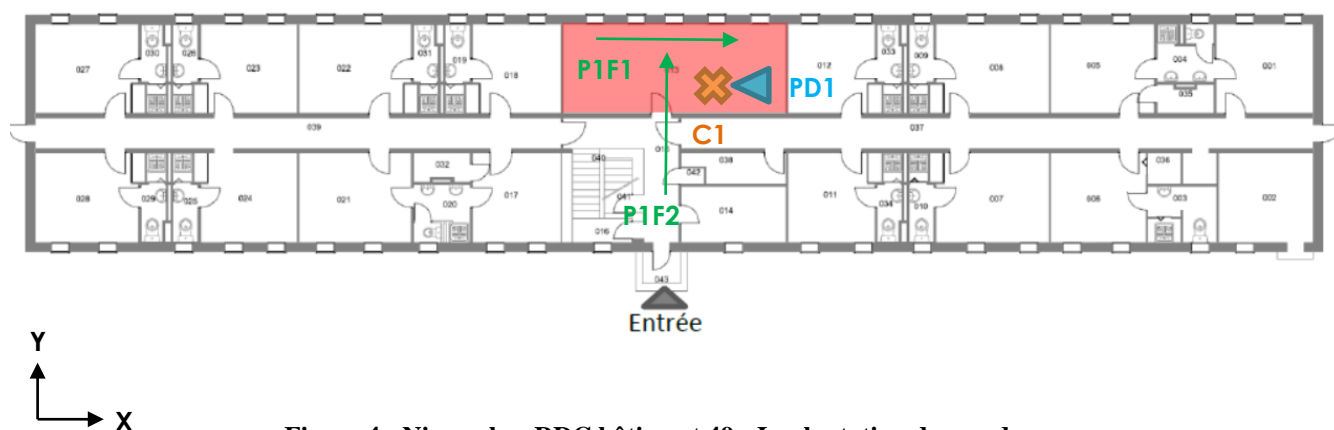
Niveau bas RDC bâtiment 49 - Implantation des sondages
